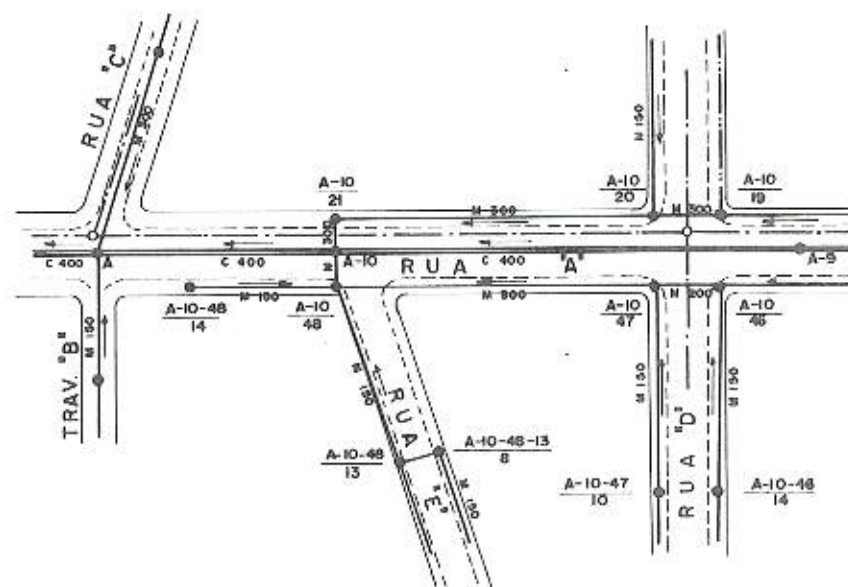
B — Planta baixa de execução — esc. 1:1.000.
